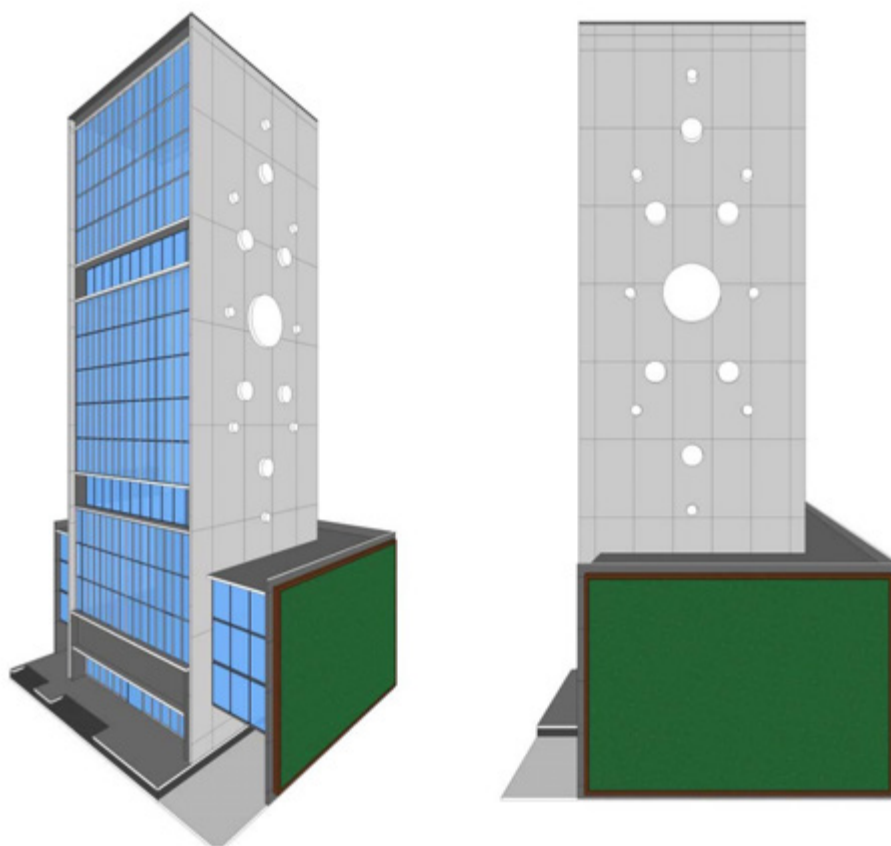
Спроектированное высотное здание с динамическим фасадом
